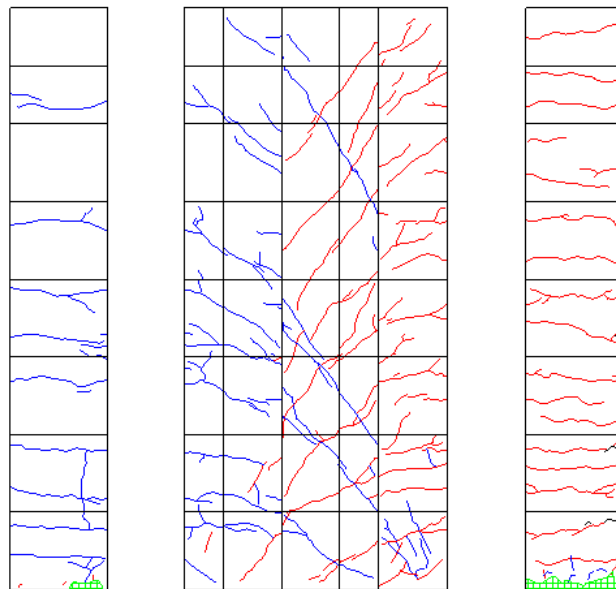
R=1/33 ひび割れ図
